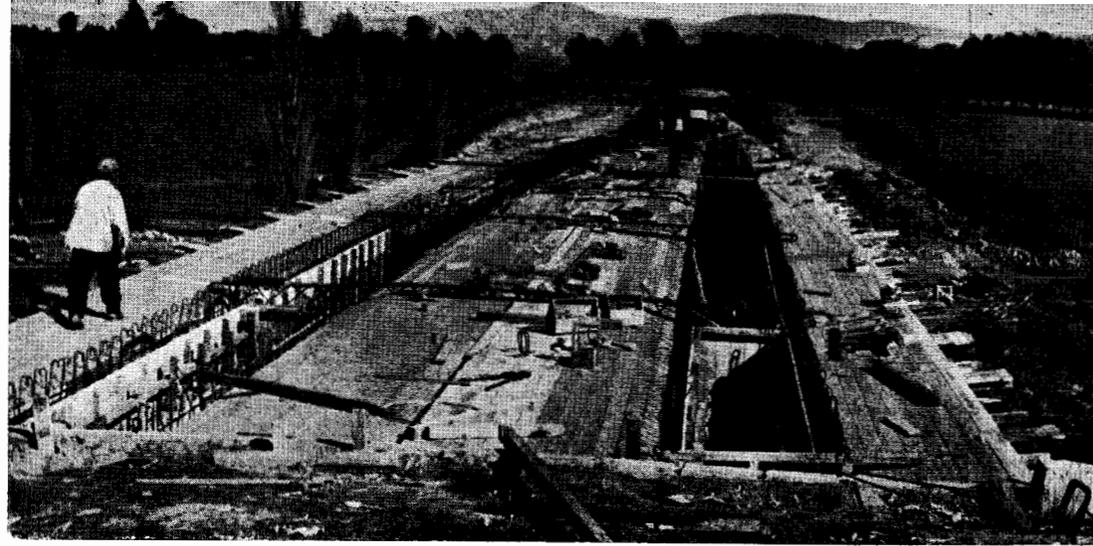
Puente sobre el Sauce Grande. — Encofrado de calzada entre vigas huecas; la parte de calzada encima de aquéllas se realizará una vez hormigonada la pantalla que forma el alma de las mismas.
